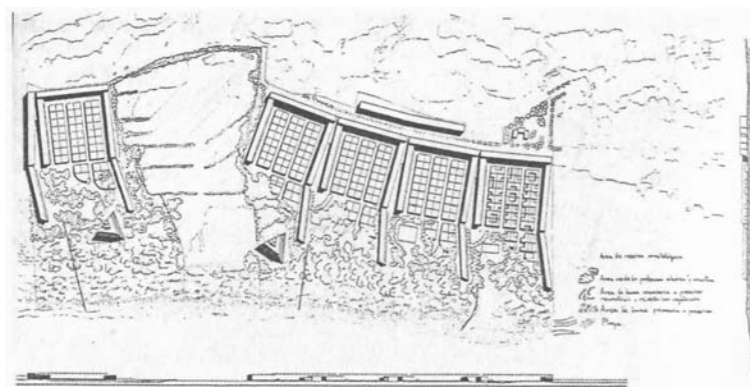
PORTAS, Nuno – Plano para 1500 vivendas, Vila do Conde, 1983. Planta do conjunto.
